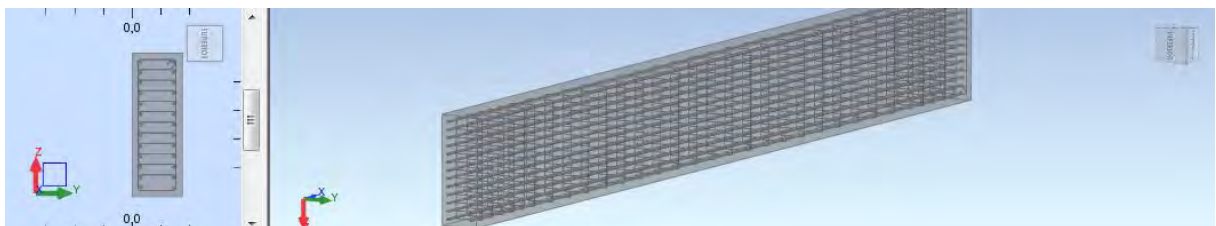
DETALLE DE ARMADURA DE LA VIGA
